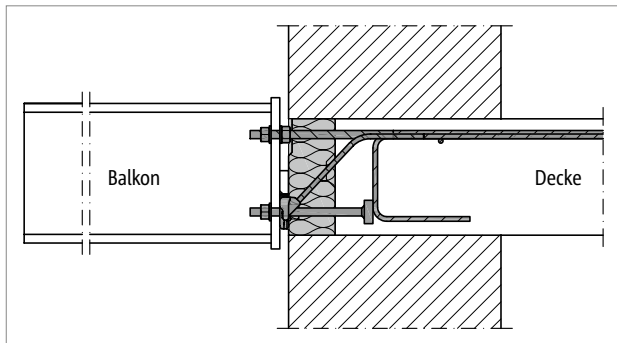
Schöck Isokorb® T Typ SKP: Anschluss an die Stahlbetondecke; monolithische Konstruktion der Wand
